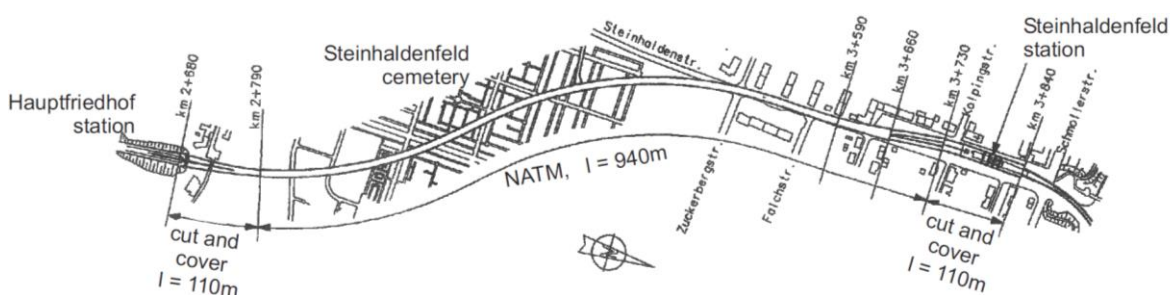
Plano en planta del trazado del Túnel de Steinhaldenfeld y tramificación según el procedimiento constructivo utilizado (Möller, 2006).
